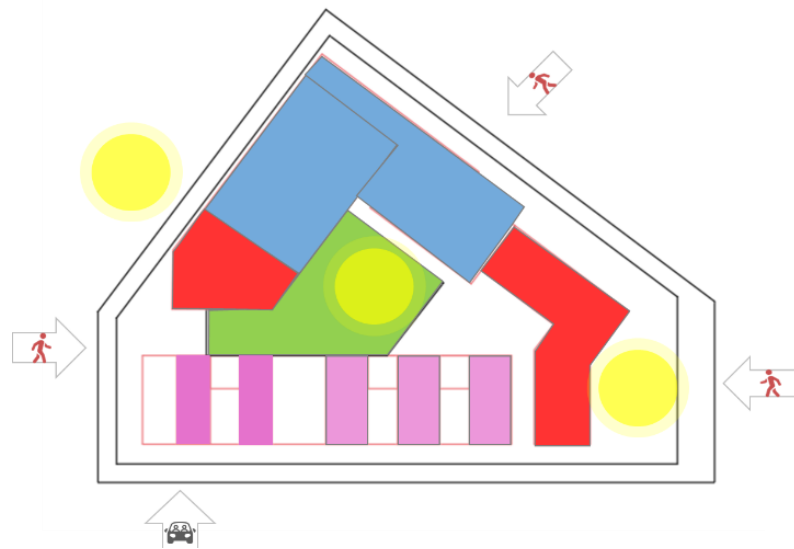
Planta esquemática del proyecto según los usos propuestos.
